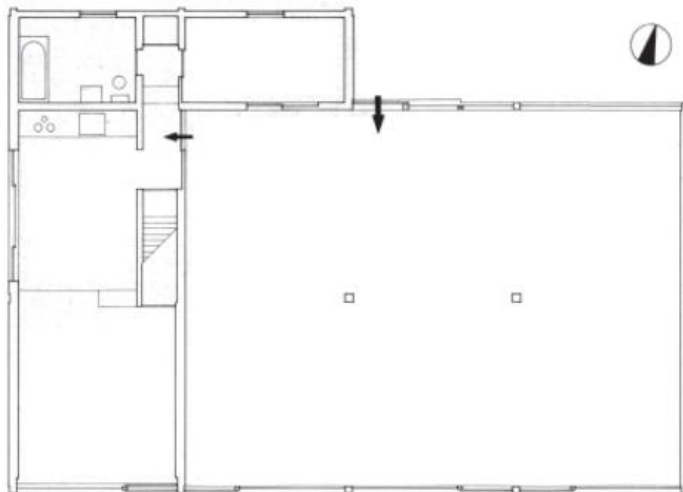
Planta do pavimento térreo da Casa Tanikawa
